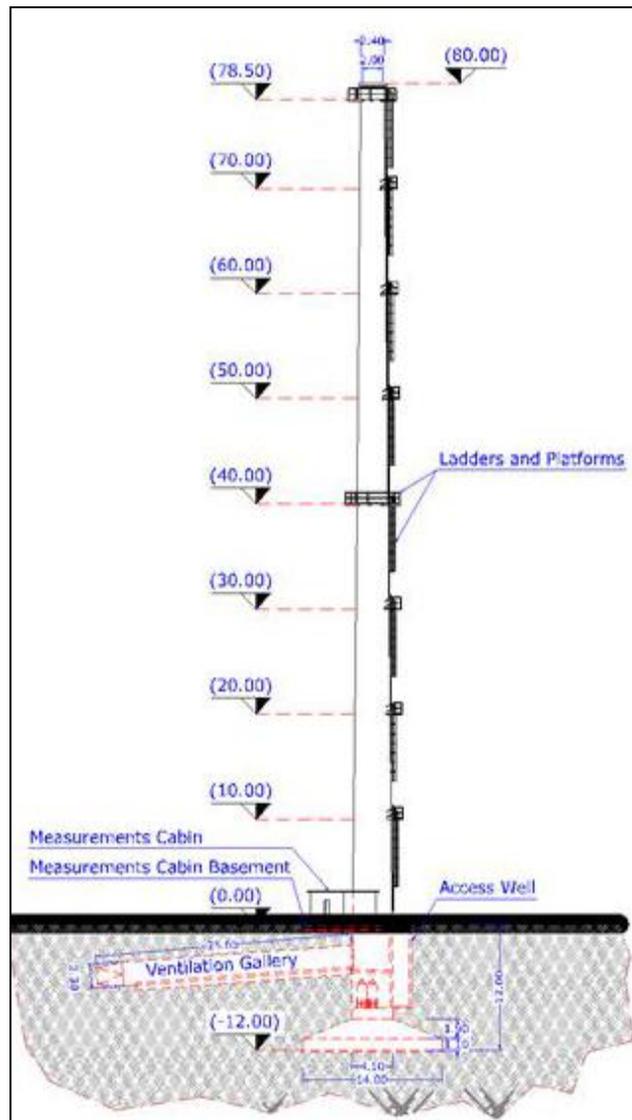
Edificio 88 (Camino di ventilazione) – Sezione frontale
